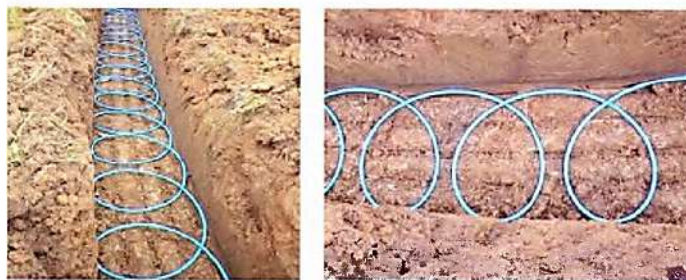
Спосіб укладки горизонтального ґрунтового теплообмінника [19]
